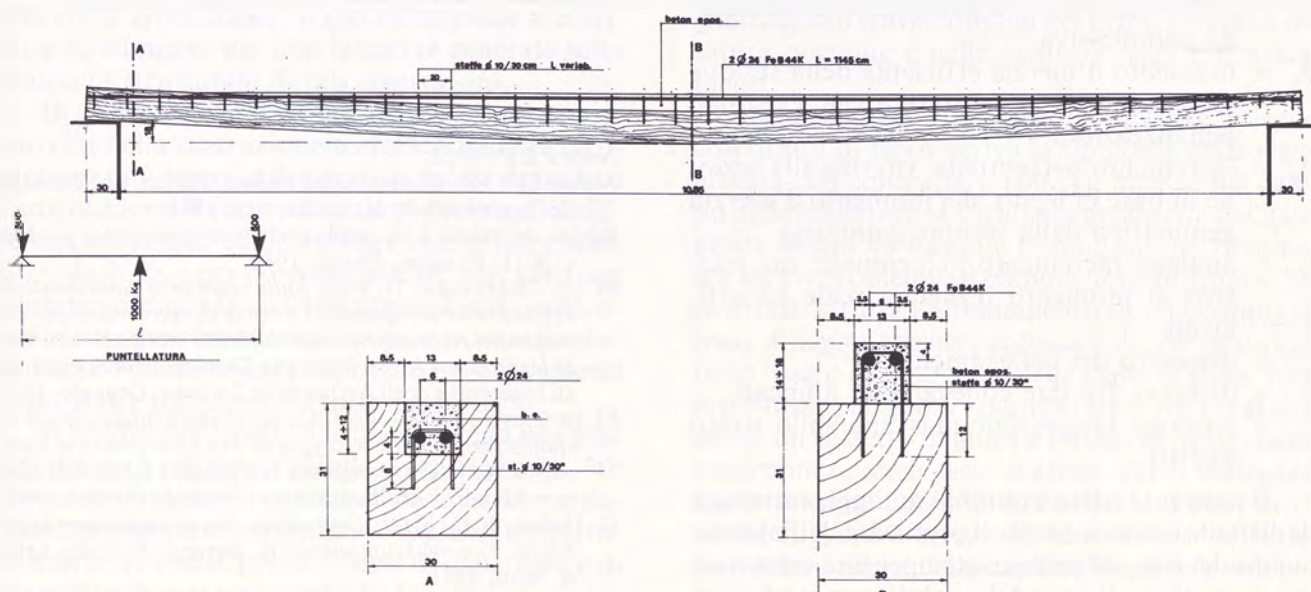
M. de Cristofaro, D. Fois: progetto di consolidamento delle travi di sottotetto della Biblioteca Conventuale di Monteripido a Perugia. Il cordolo in béton epossidico armato si adatta spontaneamente alle preesistenti deformazioni, realizzando sistemi del tipo ad uniforme resistenza a flessione.
